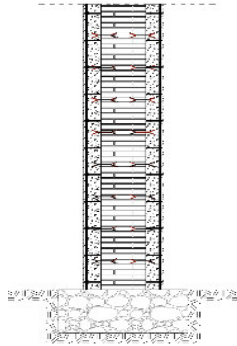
Camisa de hormigón armado. Rehabilitar con acero.
